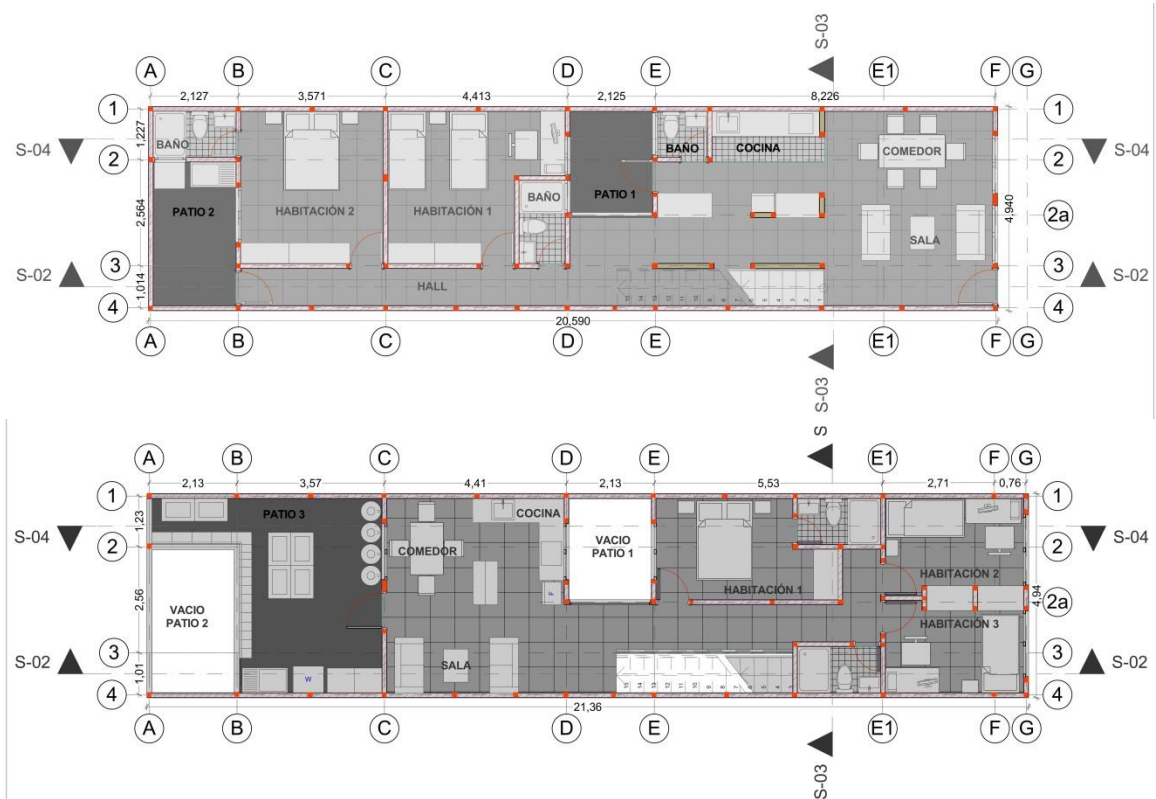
Planta primer y segundo piso propuesta, indicando columnetas de confinamiento para los muros proyectados, Elaboración propia 2017.
